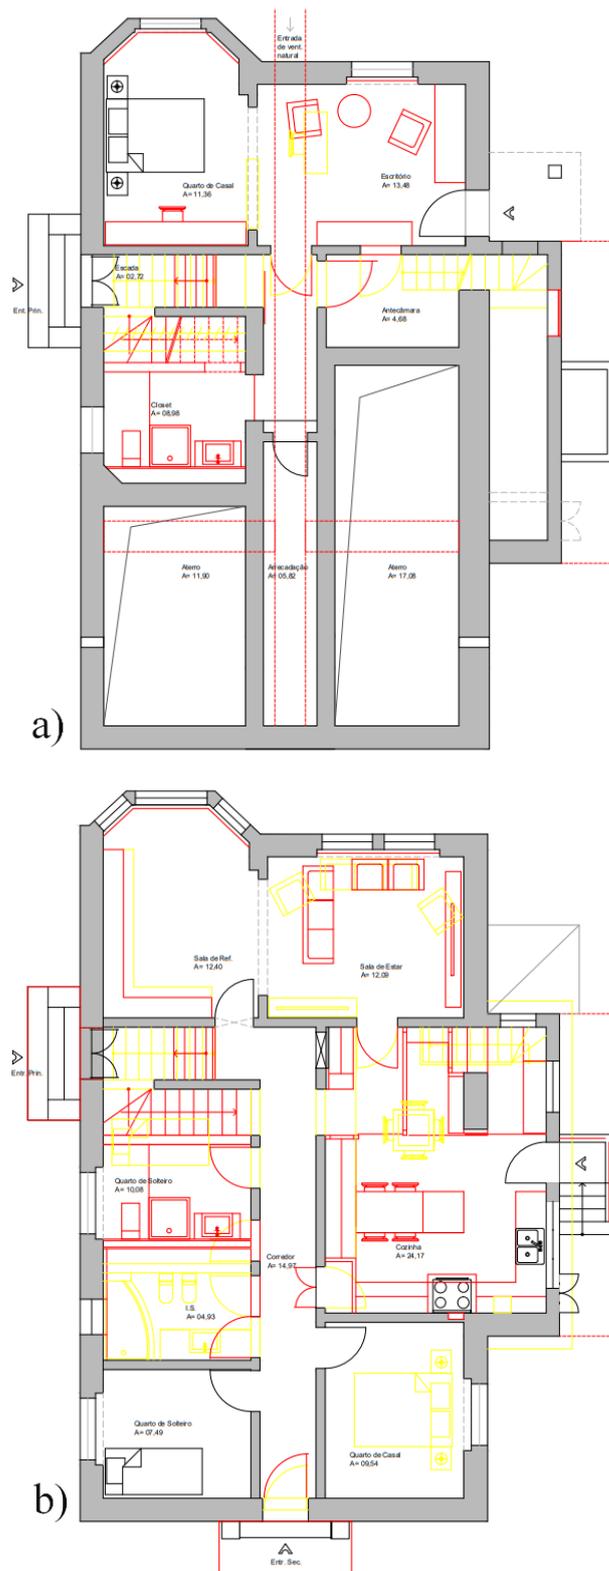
1 – Representação das plantas da moradia (vermelhos [a construir] e amarelos [a demolir]: a) planta da cave; b) planta do piso 0 (Fonte: de autor).
